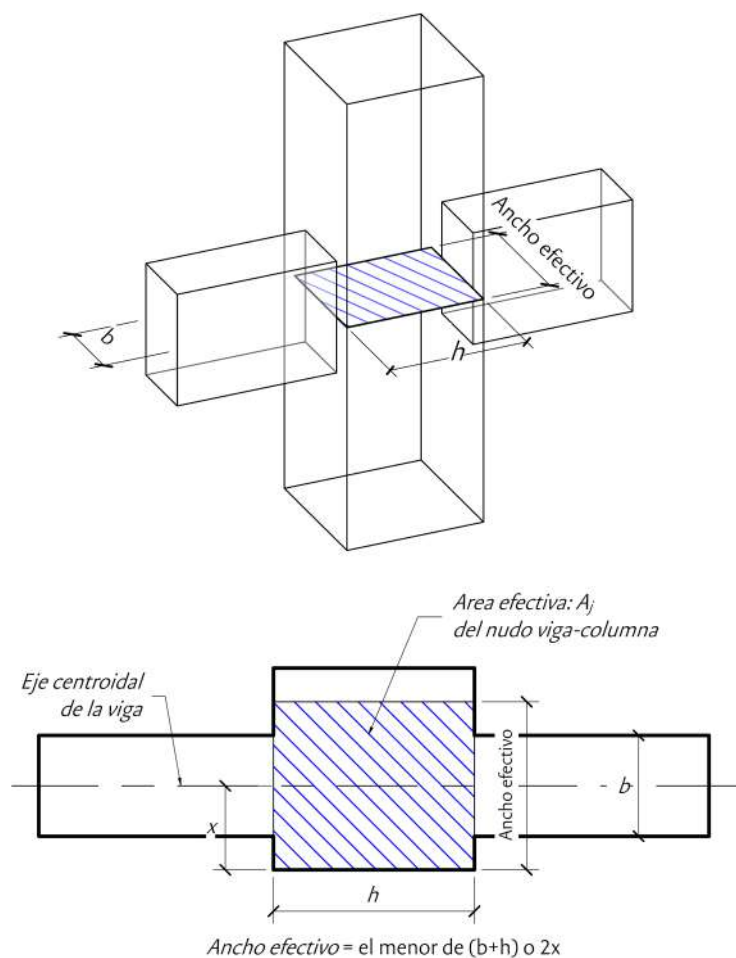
Área efectiva del nudo. Referencia: 5.12.1.10.4.
